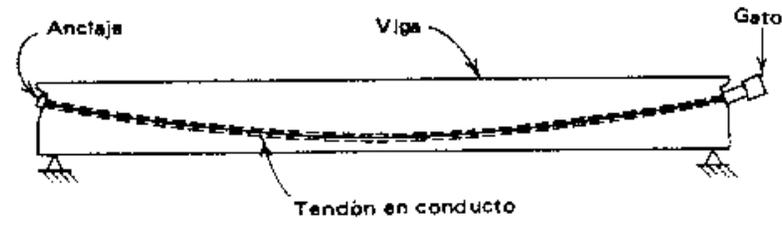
DETALLE DE LOSA POSTENSADA. SECCIÓN. VISTA DE TORÓN Y ANCLAJES
